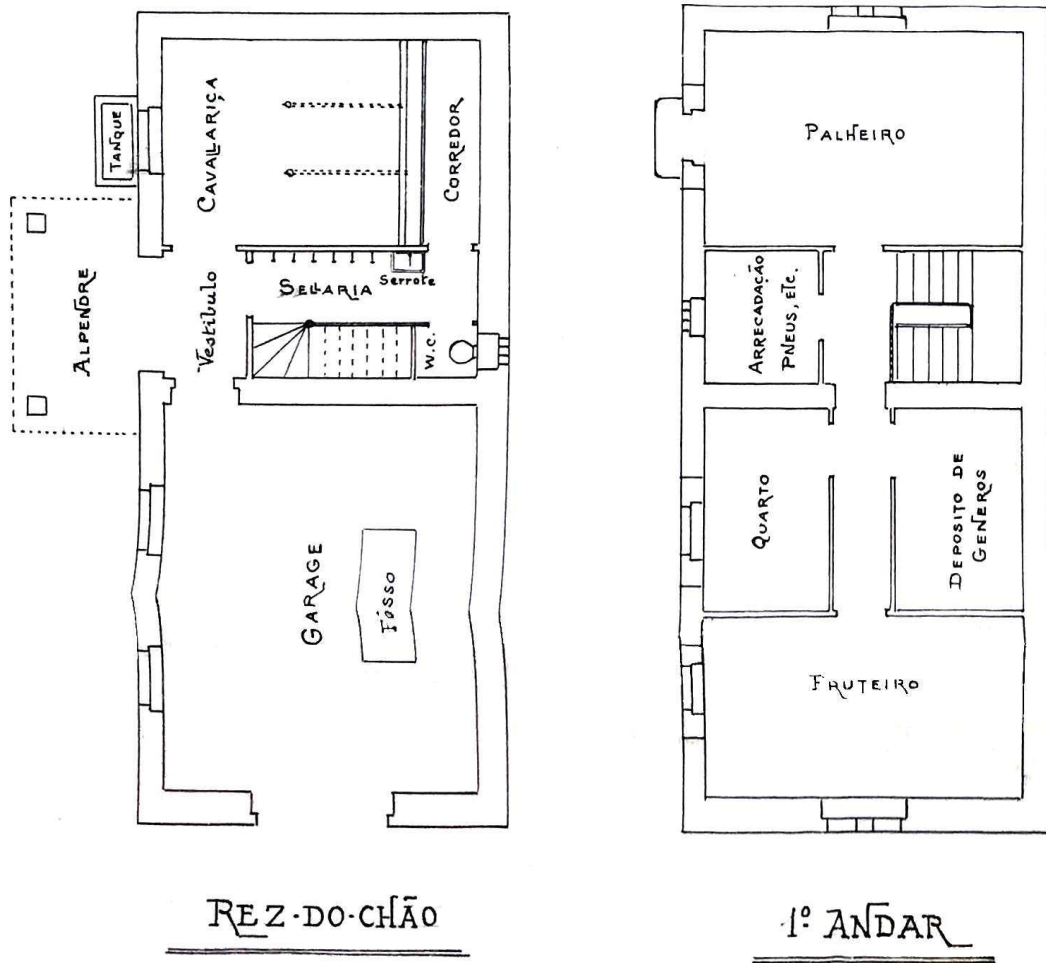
Planta de rés-do-chão da garagem. Figura 78 - Planta de 1º andar da garagem.
